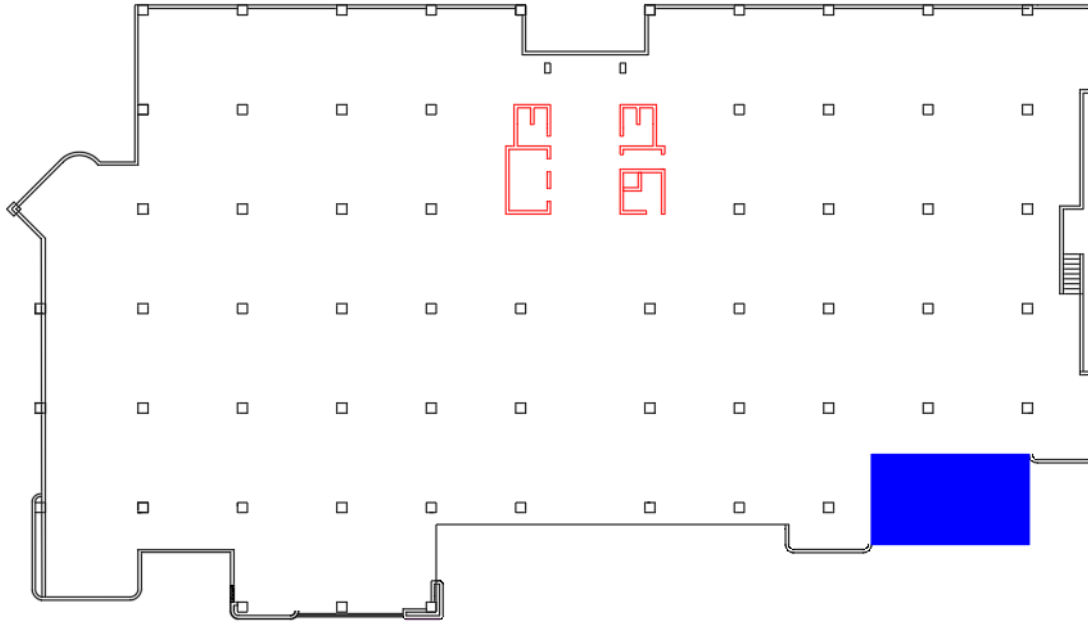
Esquema en planta de la Planta Baja del EERCs.
